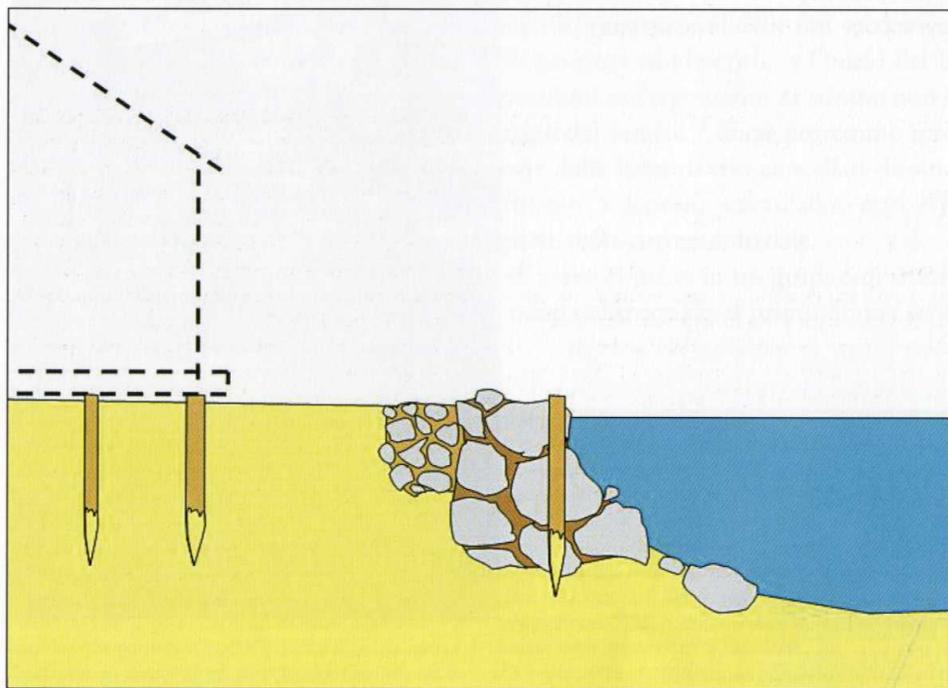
Ricostruzione dell'occupazione della riva nella fase "etrusca".
